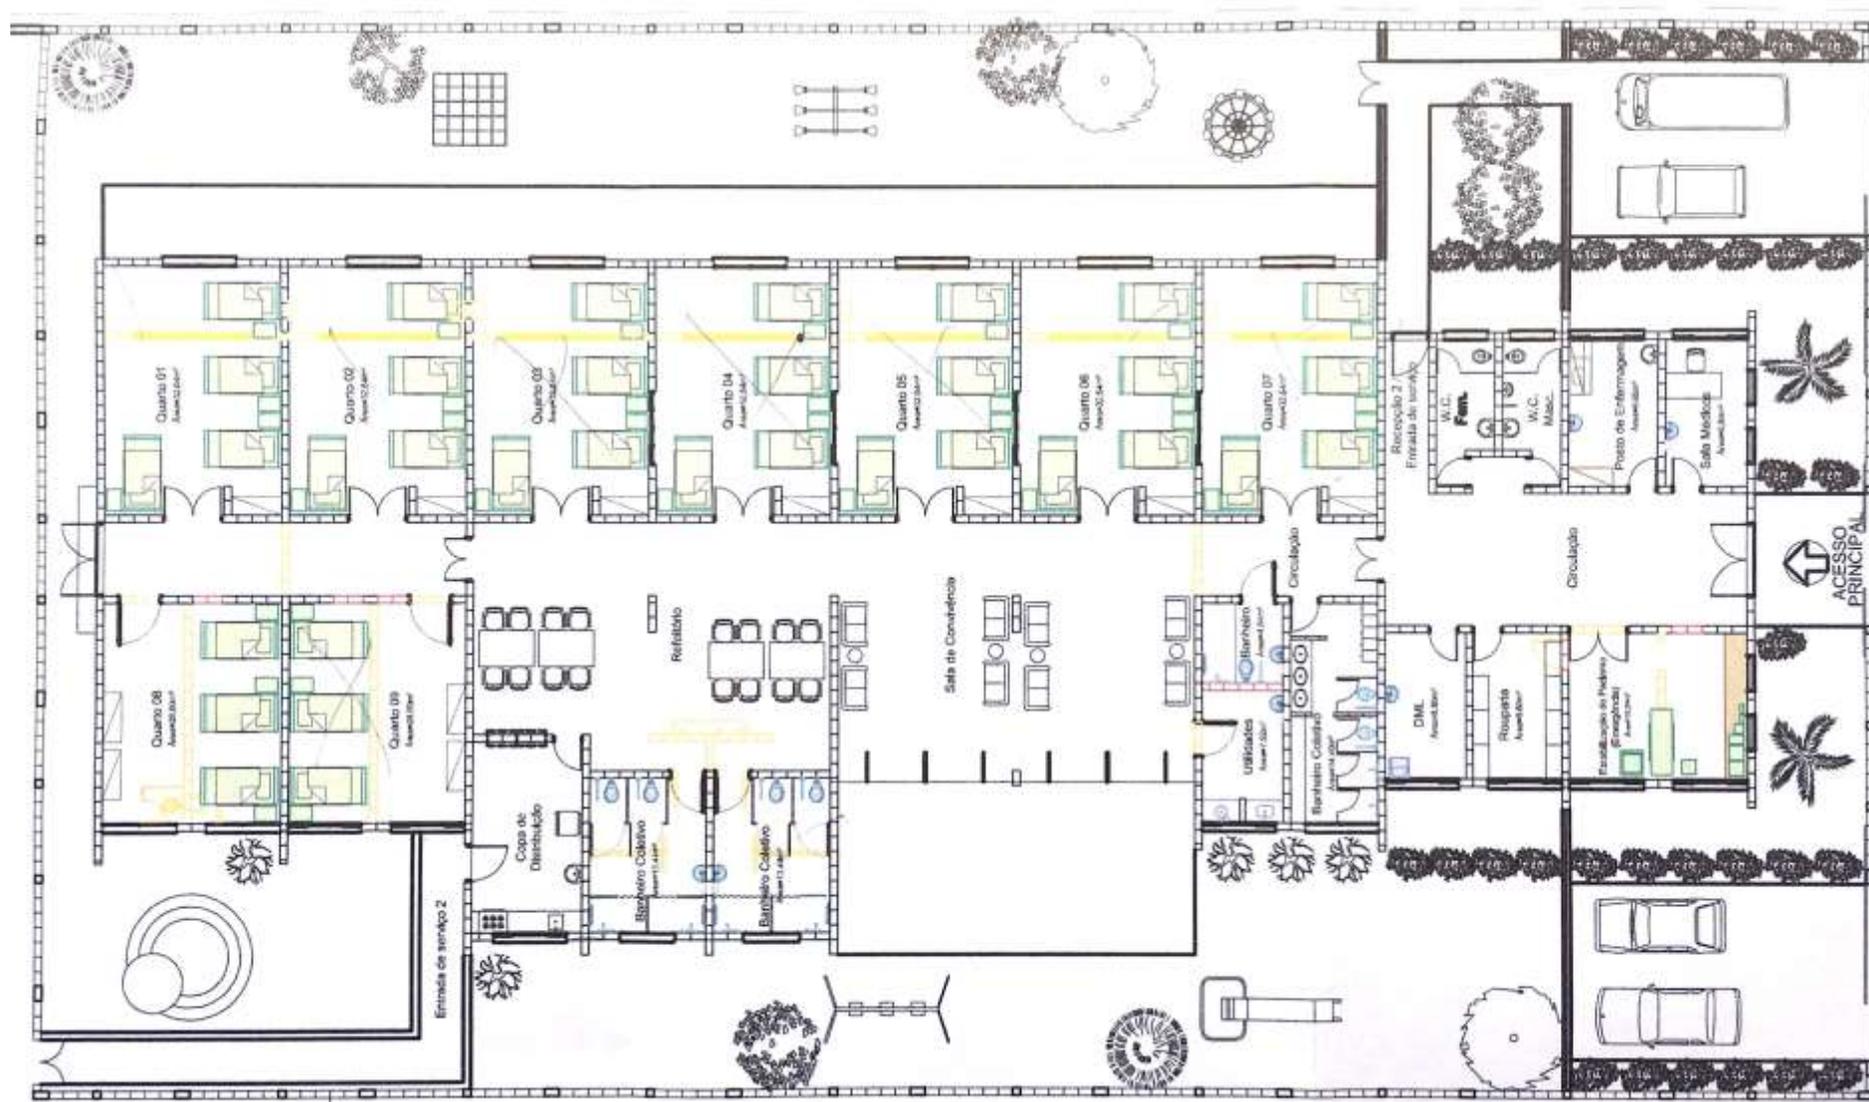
Planta do CCI de 667,16m² a ser implantado em área de creche desativada. Santa Casa de São Paulo. Avenida Guapira, Nº 2677.
